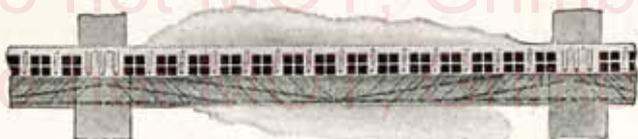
Plancher avec briques creuses, nervures et poutres, système Kahn.
